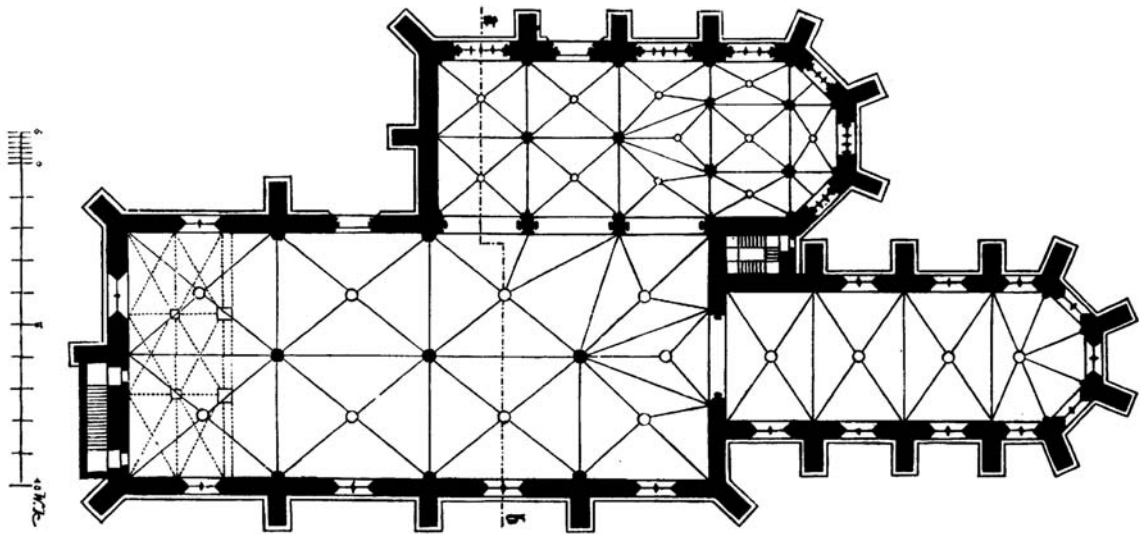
Enns (OÖ), ehem. Minoritenkirche (heute Pfarrkirche Maria Schnee) und Wallseerkapelle, Grundriß
